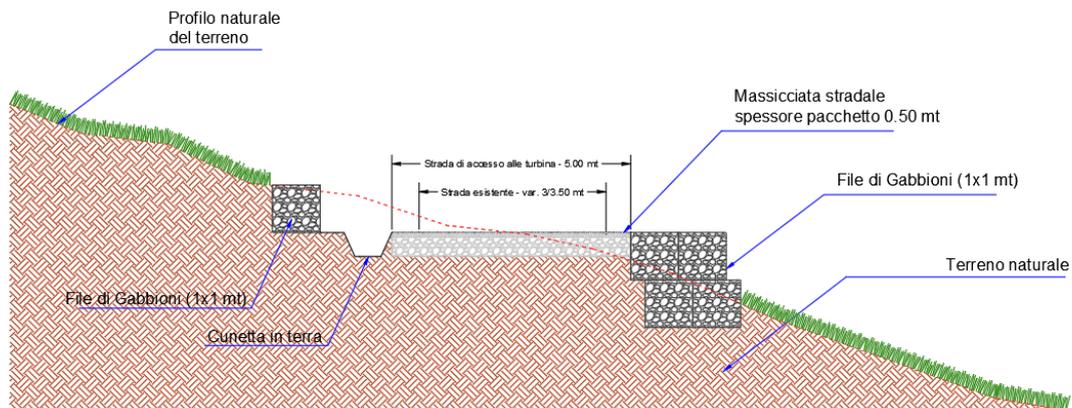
sezione tipo del tratto della strada di collegamento tra dell'aerogeneratore R-BS07 e R-BS08 ove ci sono le pendenze trasversali più elevate
